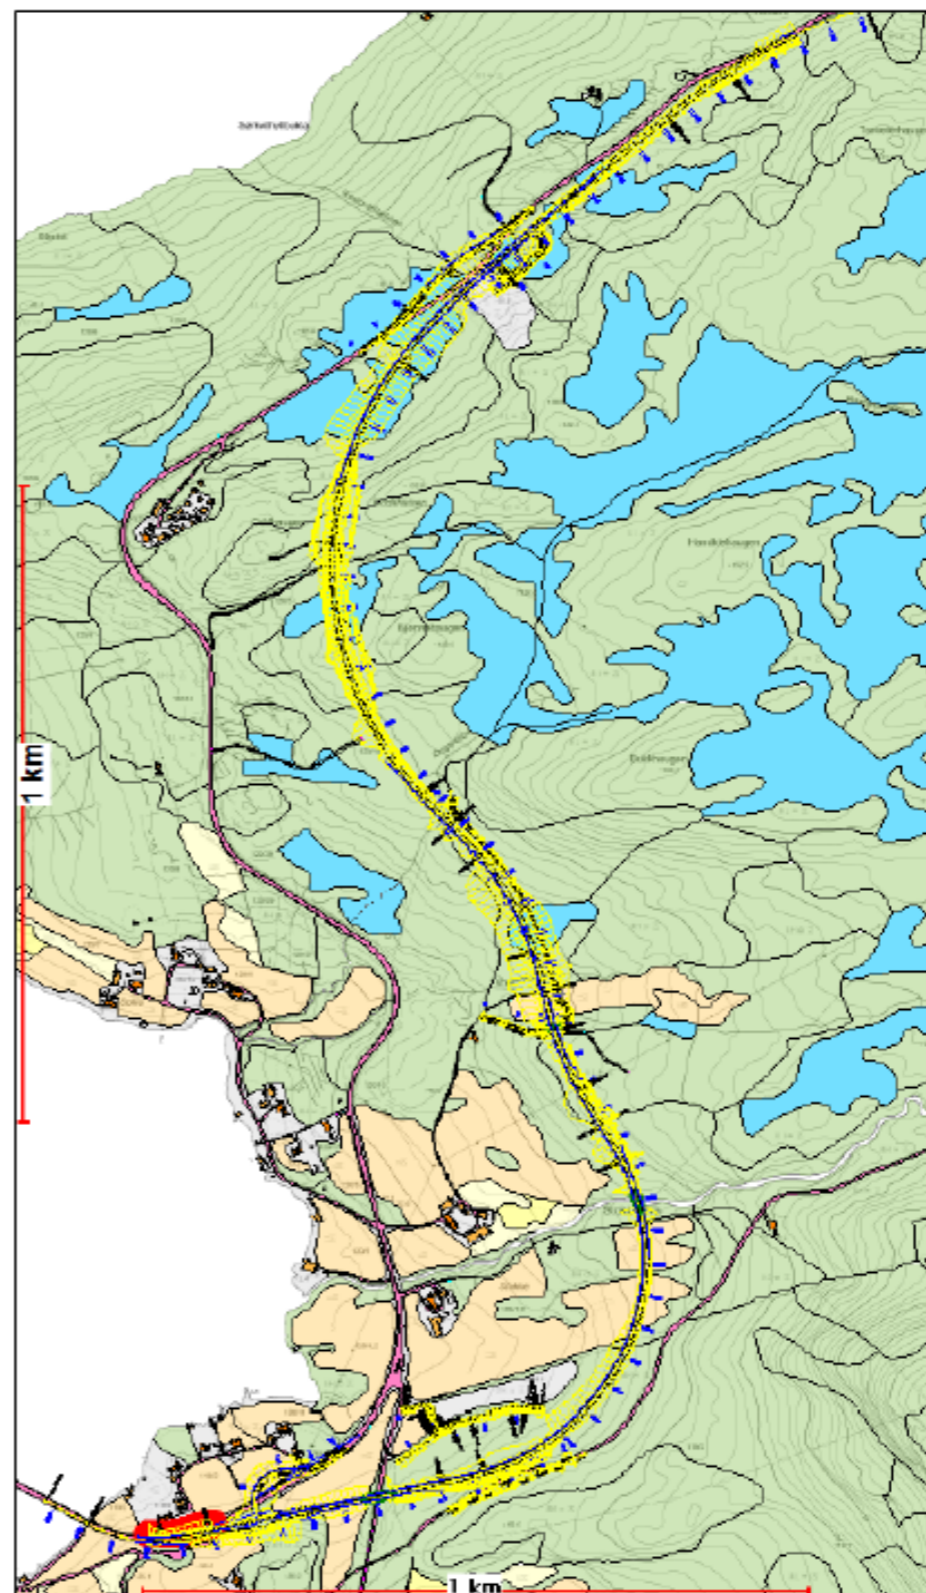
Kartutsnitt med skissert planstrekning over ny E39
